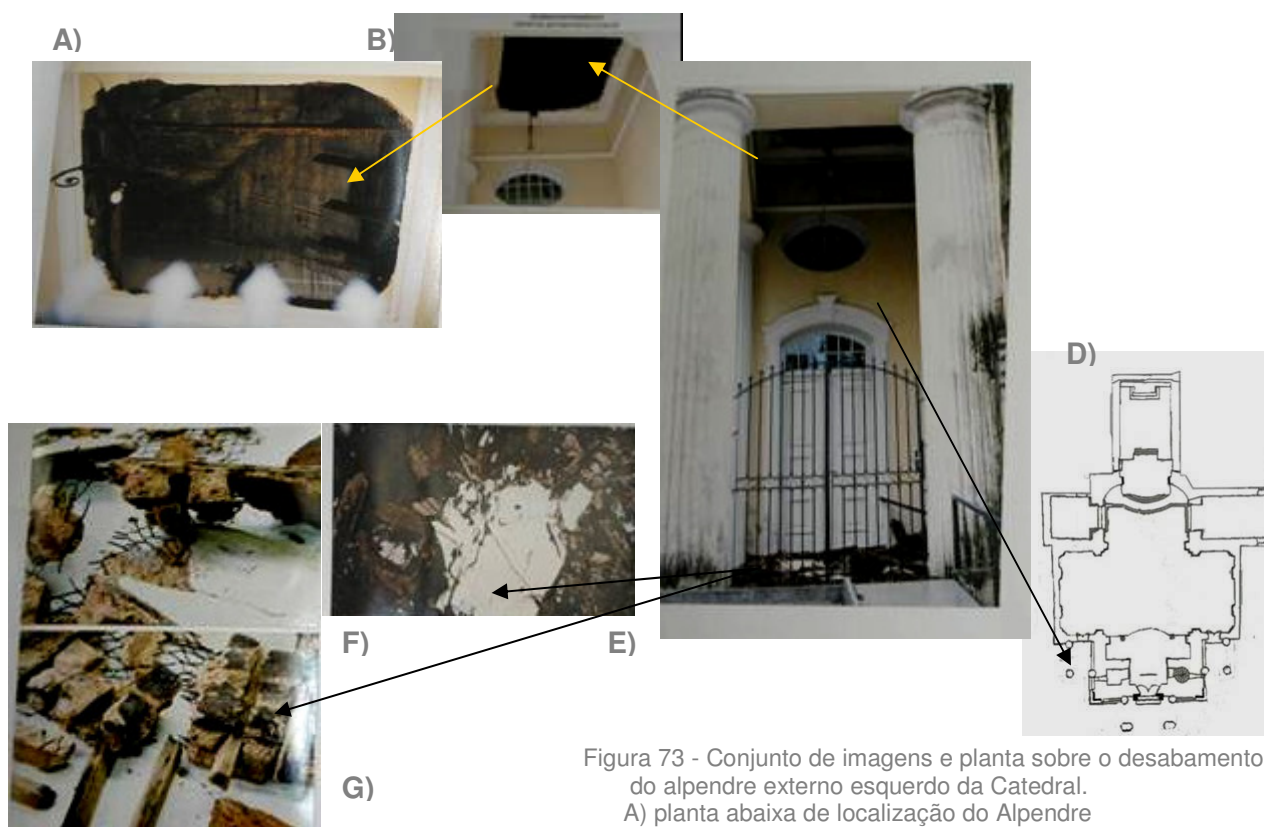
Conjunto de imagens e planta sobre o desabamento do alpendre externo esquerdo da Catedral.
